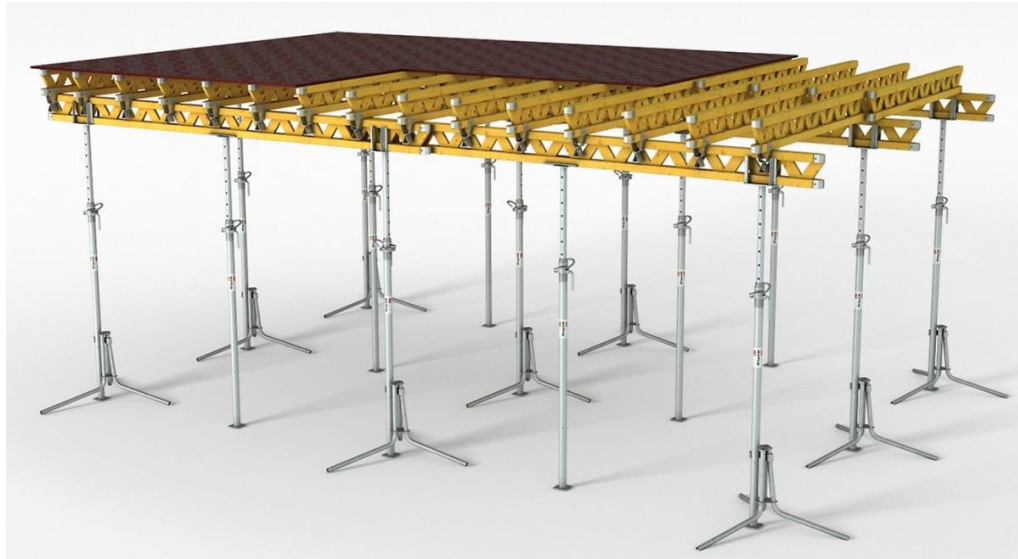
Опалубка для перекриттів MULTIFLEX
